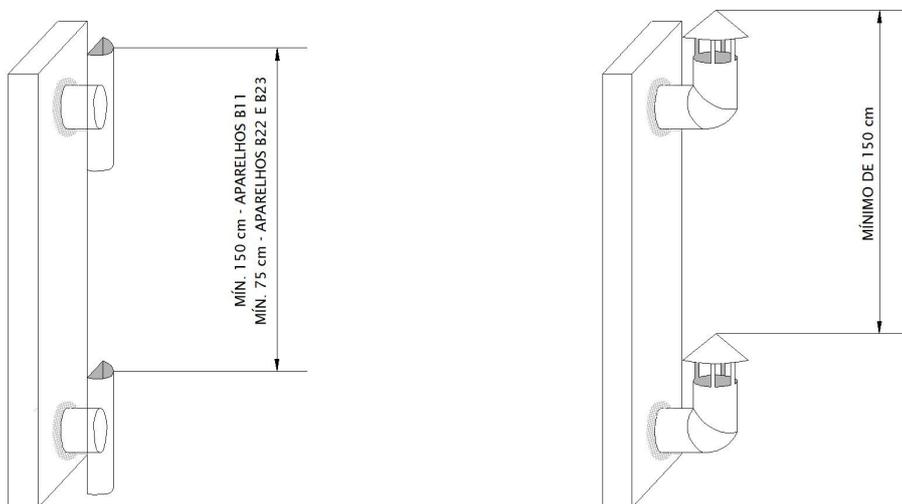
Distanciamento vertical entre terminais de chaminé.
